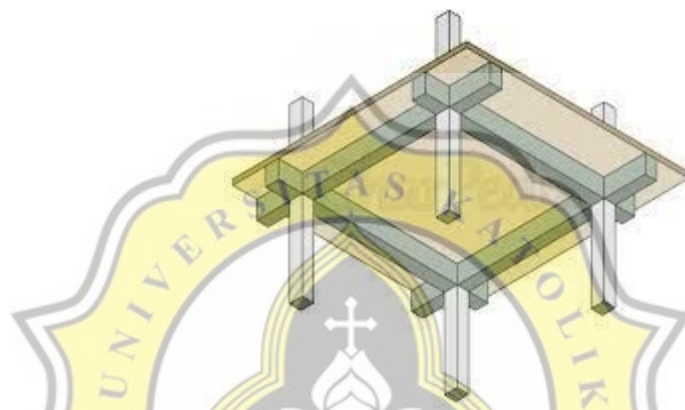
Pondasi Tiang Pancang dan Pondasi Lajur
